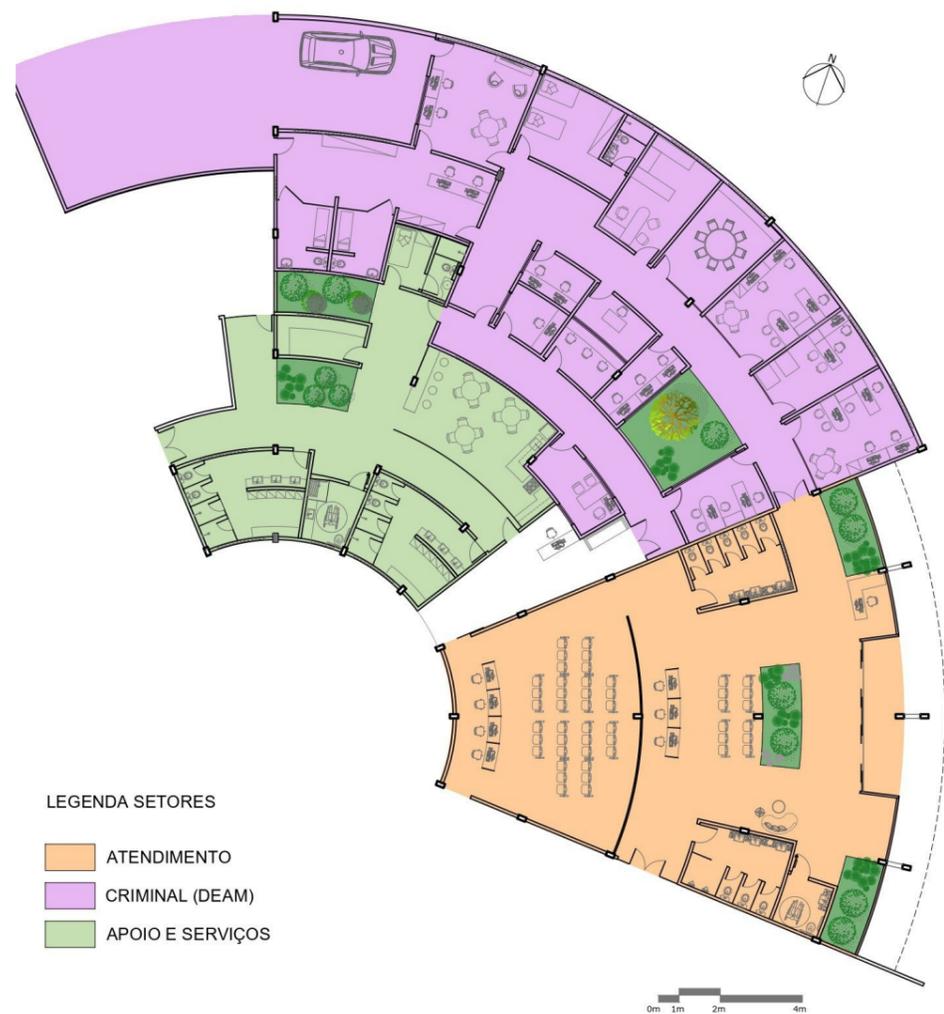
Planta Baixa dos Setores Atendimento, Criminal e Apoio e Serviços
